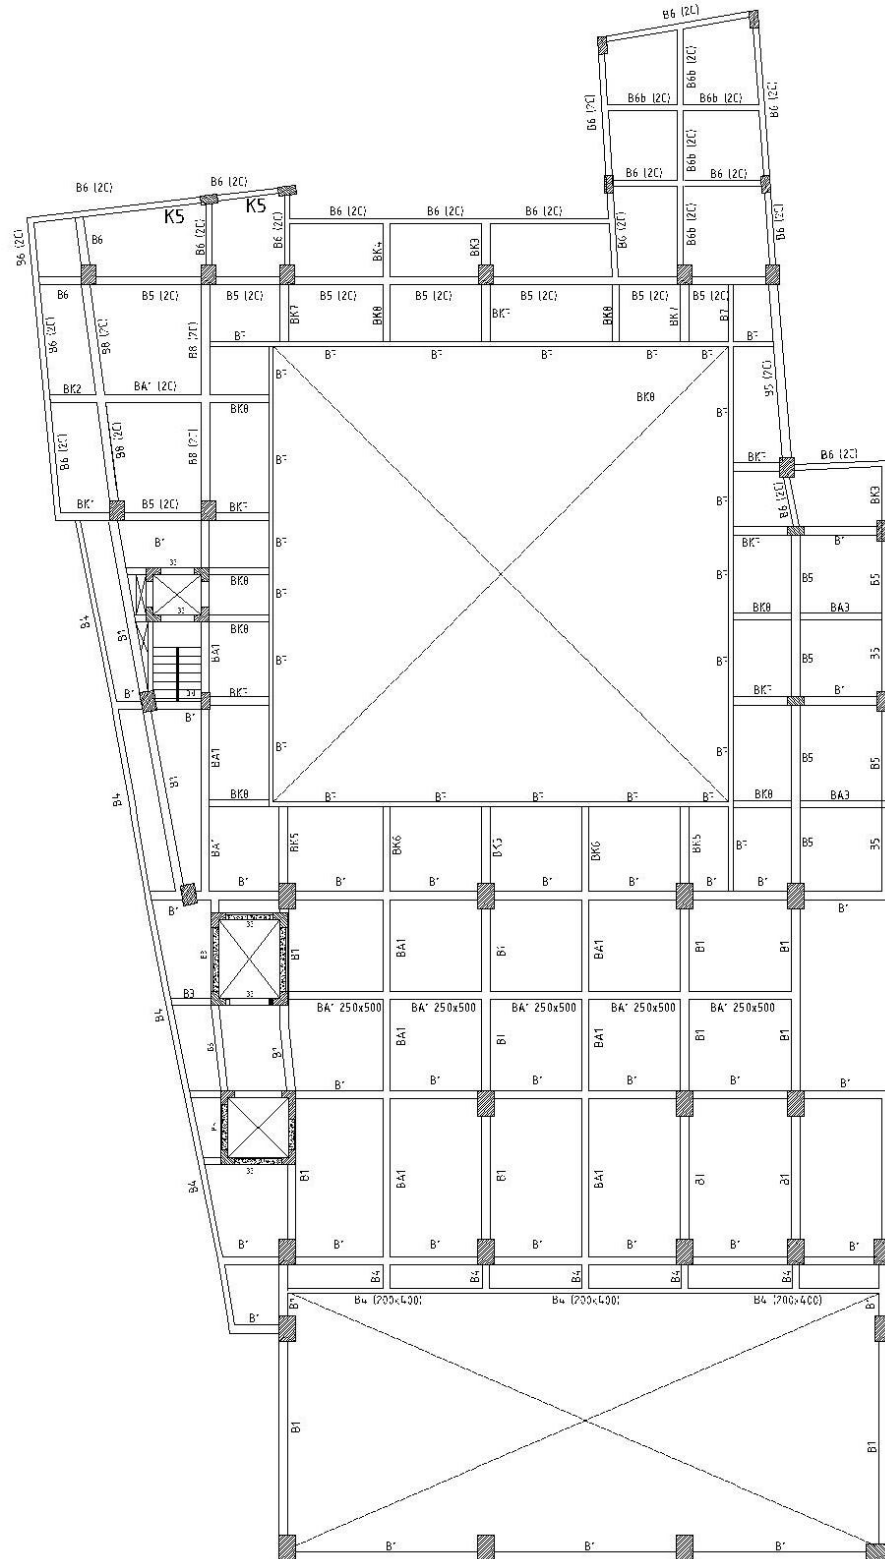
1 Denah Struktur Gedung Lantai 1
